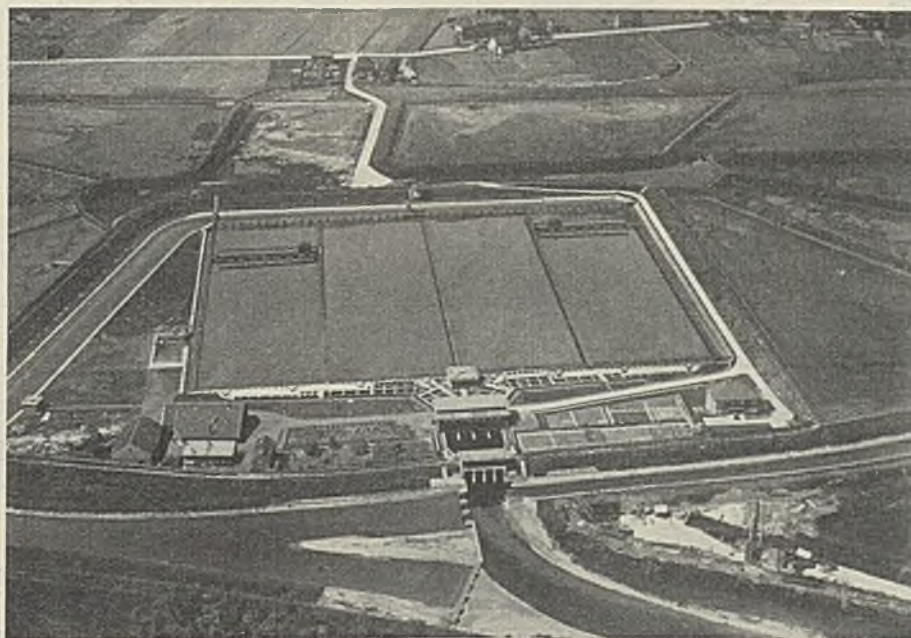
Luftbild. Im Vordergrund das Wehr, dahinter der Deichverschluß, das langgestreckte Rechenhaus und inmitten der Zulaufrihren das Schlamm-pumpenhaus von quadratischem Grundriß.
